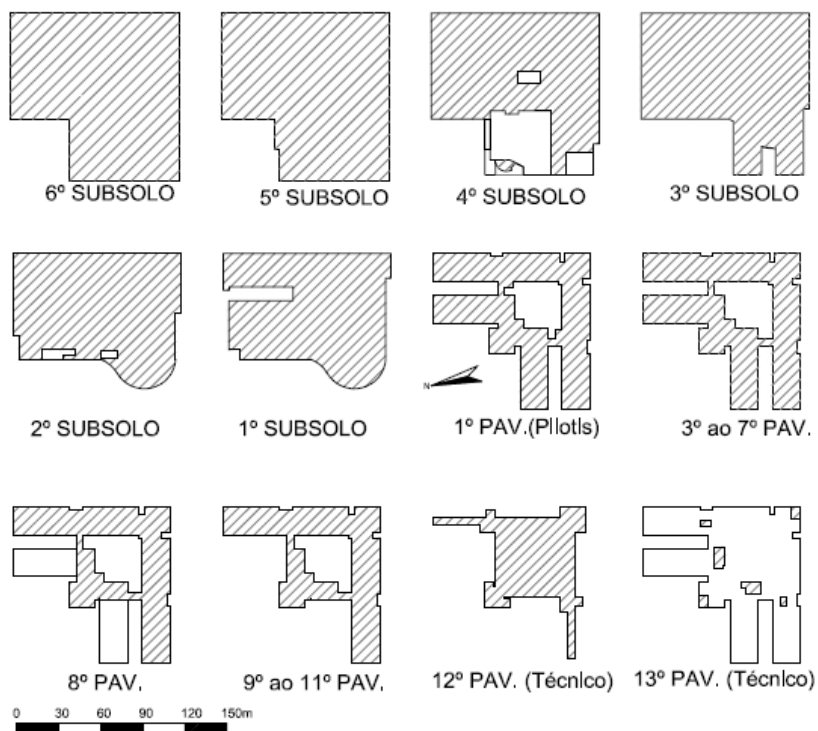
Perímetro das plantas dos pavimentos. Detalhe para indicação do Norte geográfico no 1° Pav. (Pilotis) e para terraço-jardim no 8° Pav. Fonte: Adaptado de arquivos cedidos pelo TJMG.
